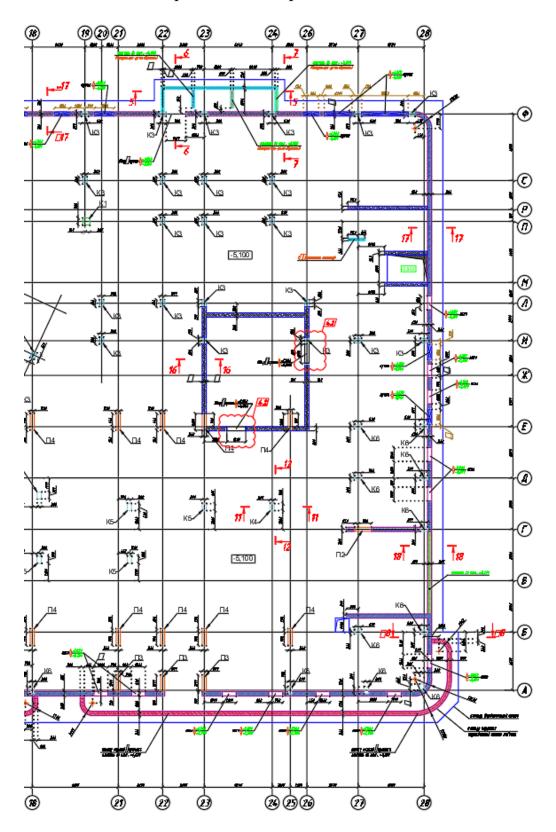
Схема расположения стен и колонн в осях 21-28. А-Ф
